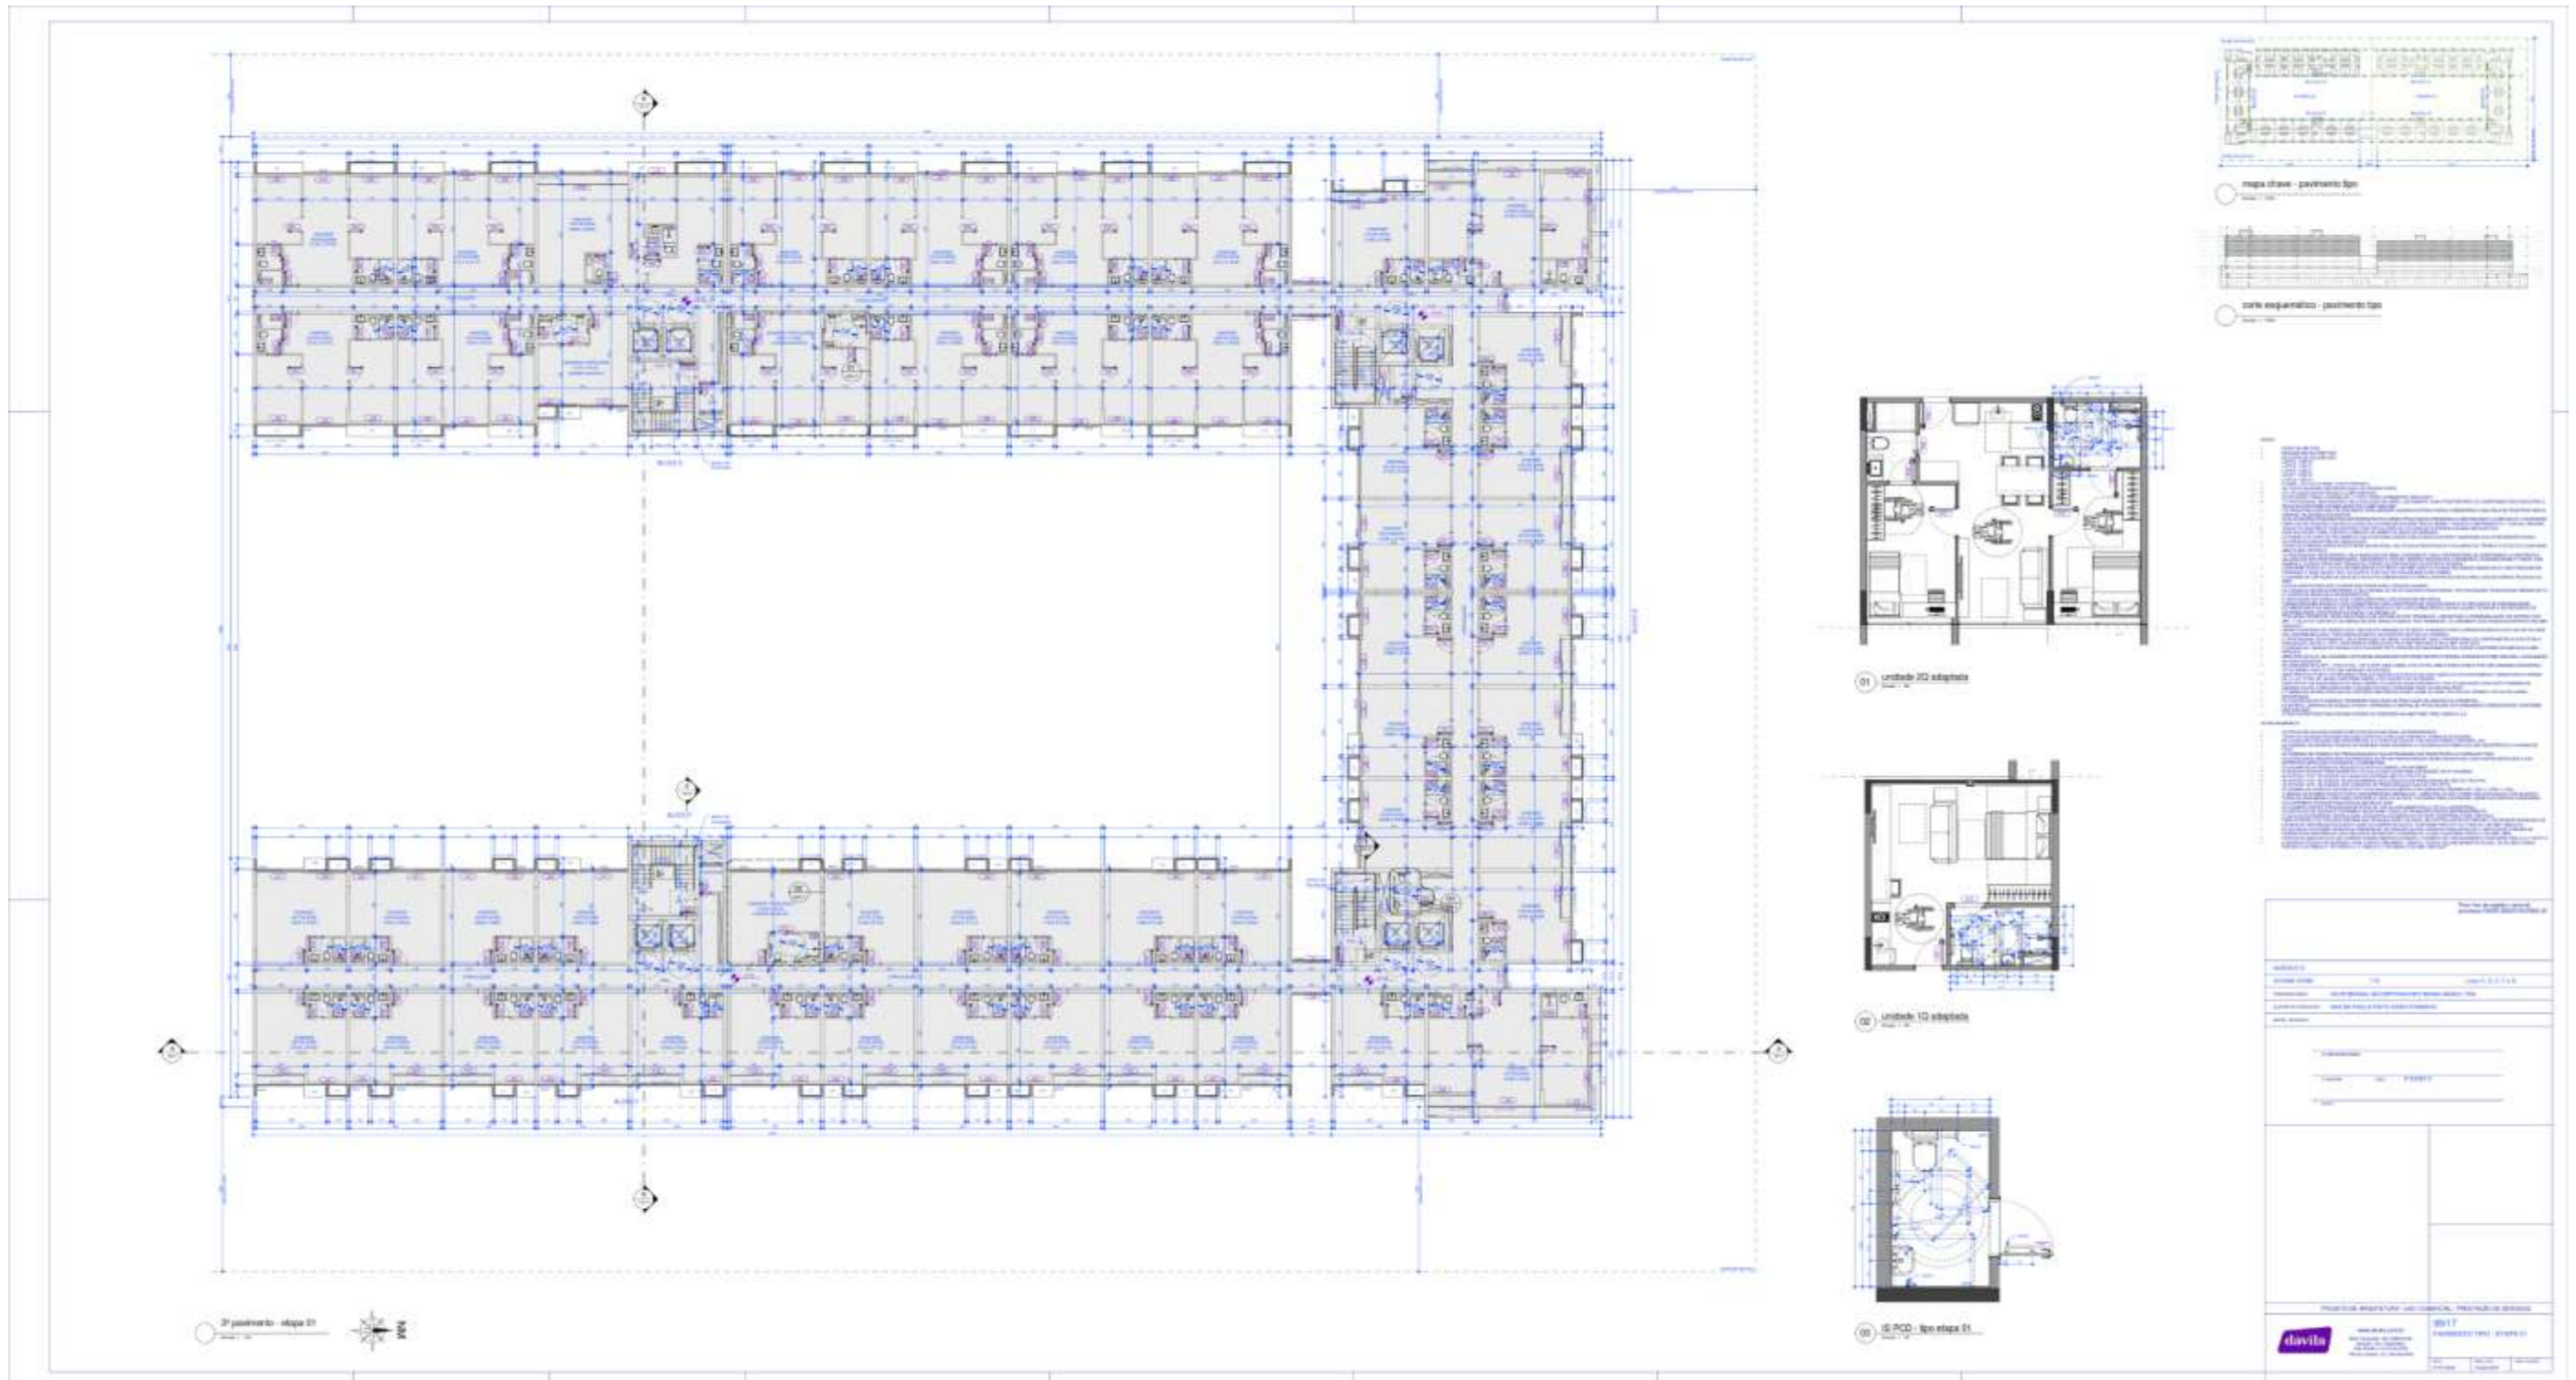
Pavimento Tipo – Etapa 01. Fonte: Estudo Prévio, em anexo.
